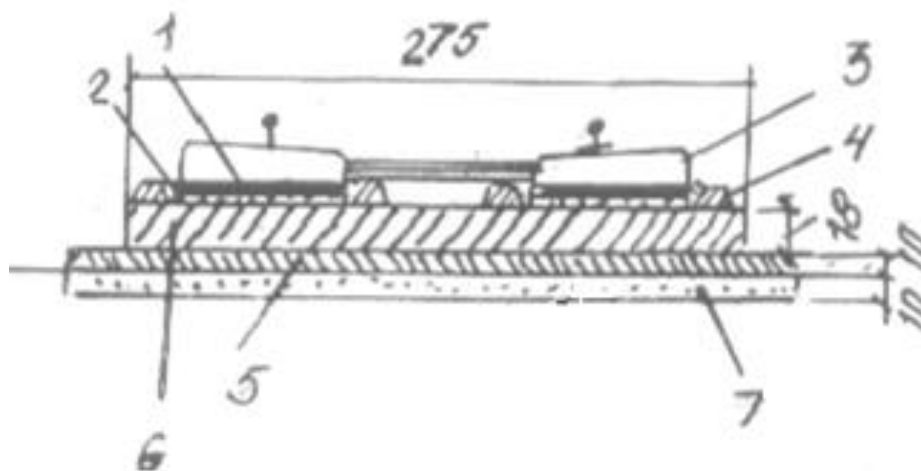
Железобетонная плита с упруго опирающимися на неё двухблочными шпалами (Франция): 1 – резиновая прокладка; 2 – бетон; 3 – шпала; 4 – бетонный упор; 5 – несущий слой с вяжущими добавками; 6 – железобетонная плита длиной 98 м; 7 – несвязный грунт
